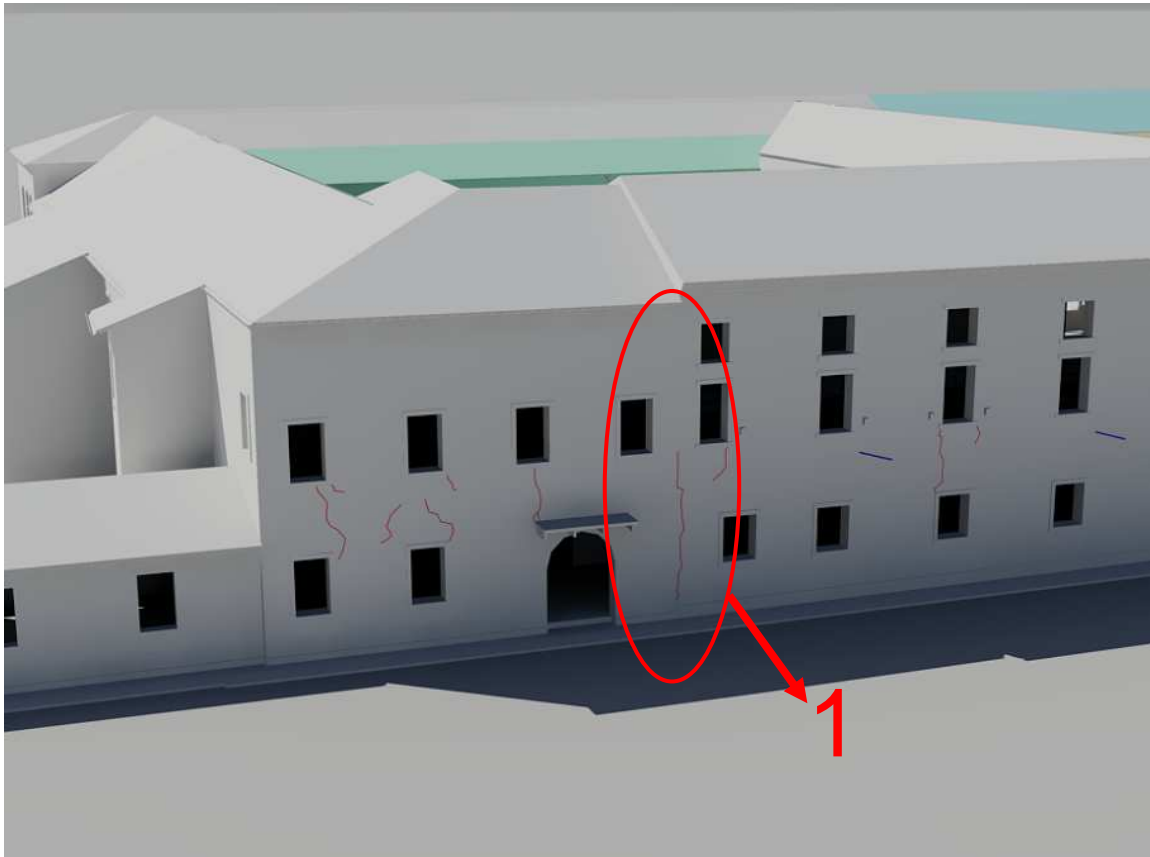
Nel particolare l'individuazione della fessura n.1.
